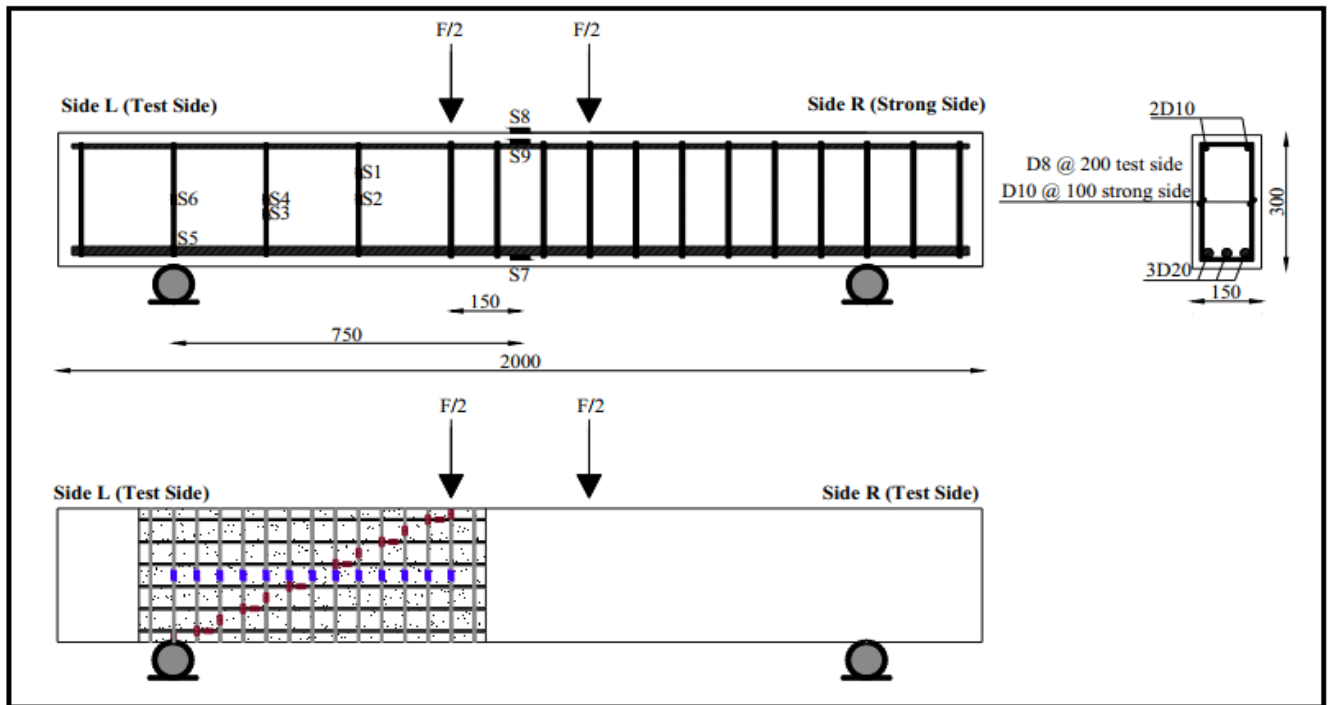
Détail du renforcement des poutres testées [Yang, X et al 2017].
